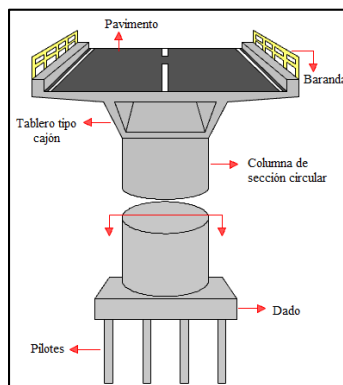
Columna sección circular con tablero de viga cajón. (Edgar, Muñoz, 2012)
